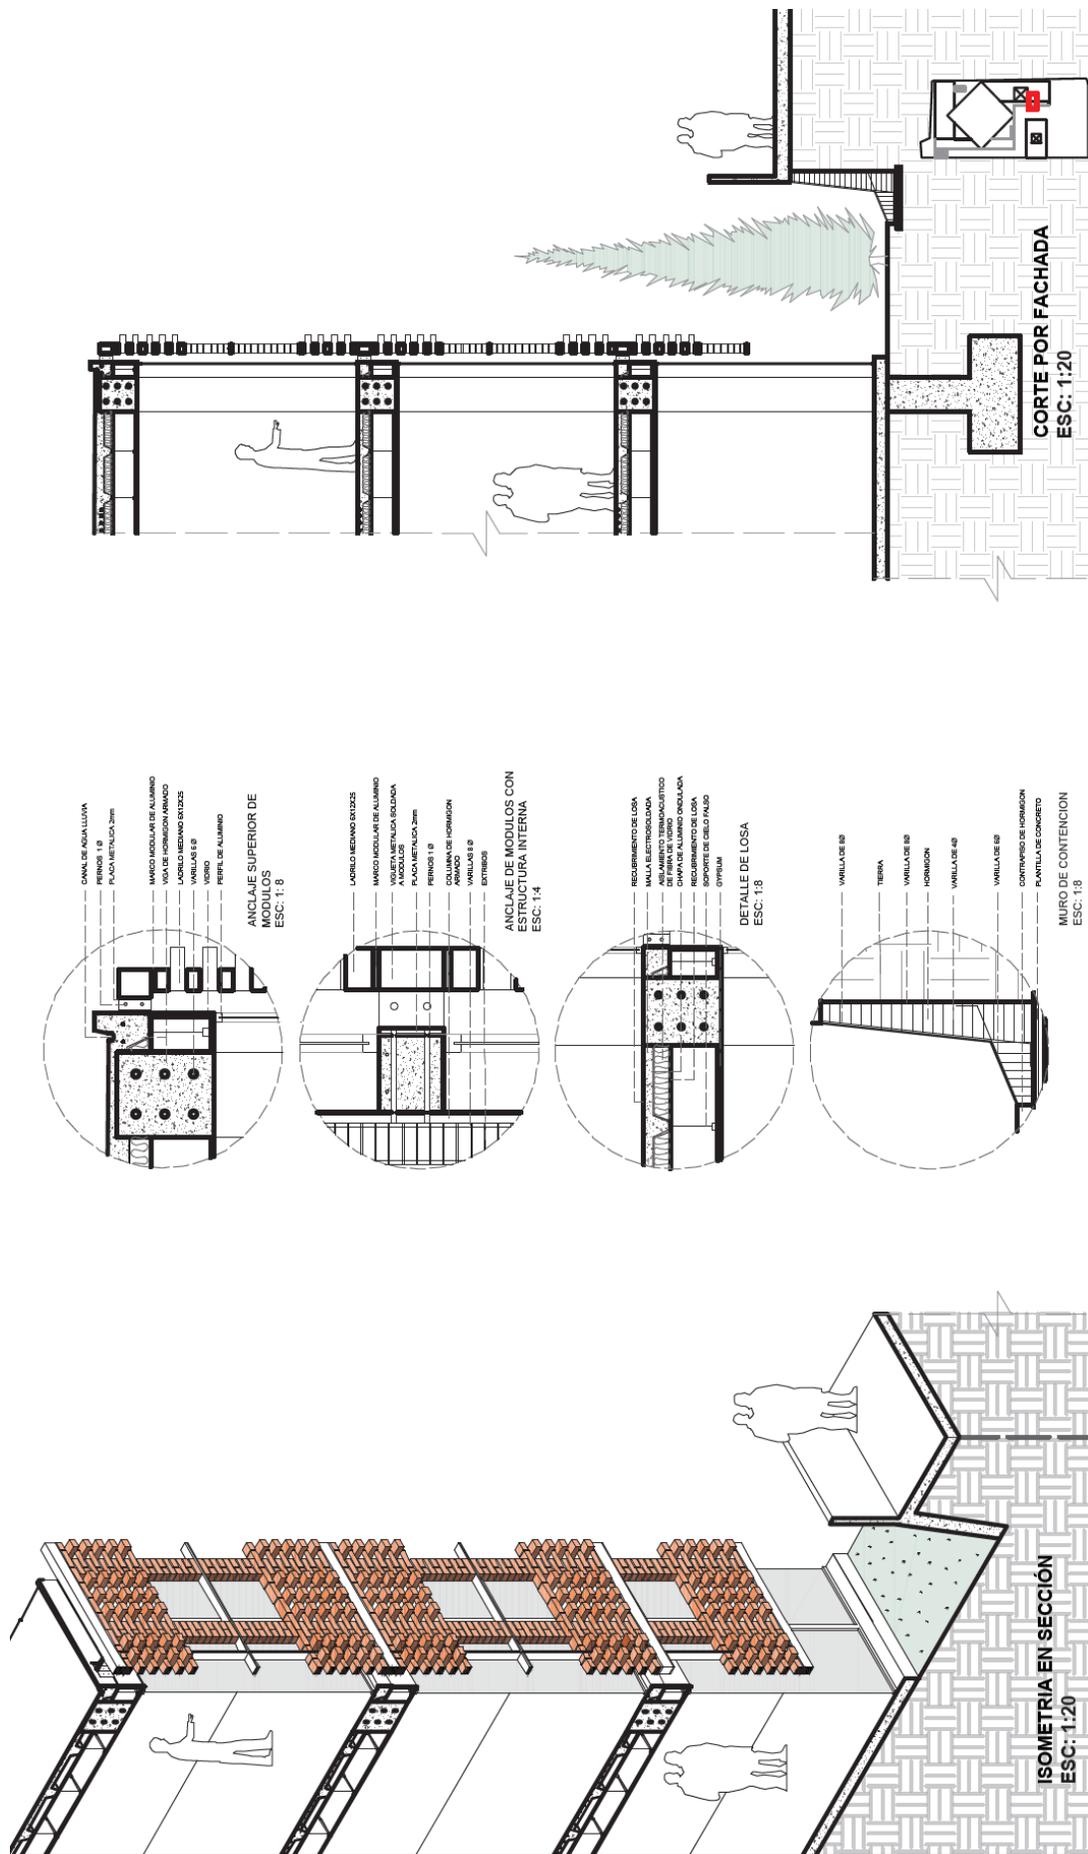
Corte Isométrico y detalles fachada de ladrillo. Elaboración propia.
